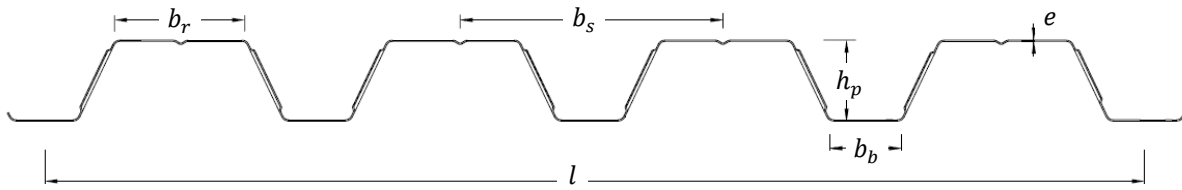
Geometria de uma chapa perfilada trapezoidal
